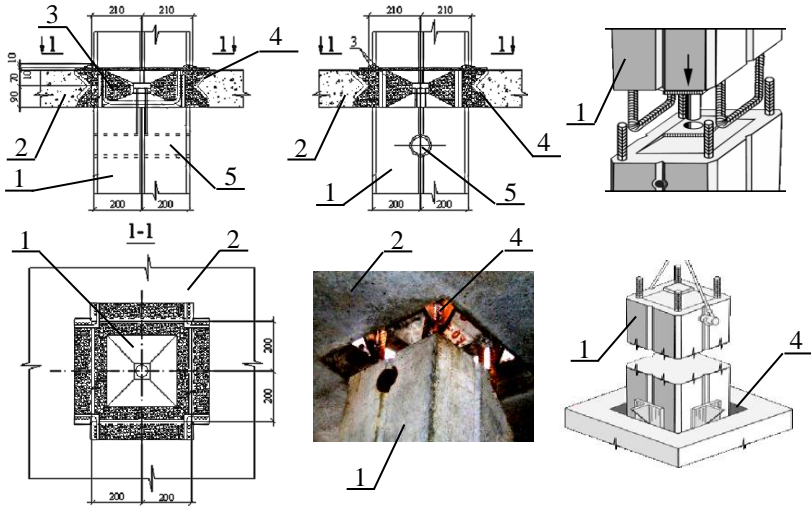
Схеми з'єднання надколонної плити з колоною: 1 – колона; 2 – плита (вид знизу); 3 – бетон; 4 – сталева обойма; 5 – монтажний отвір
